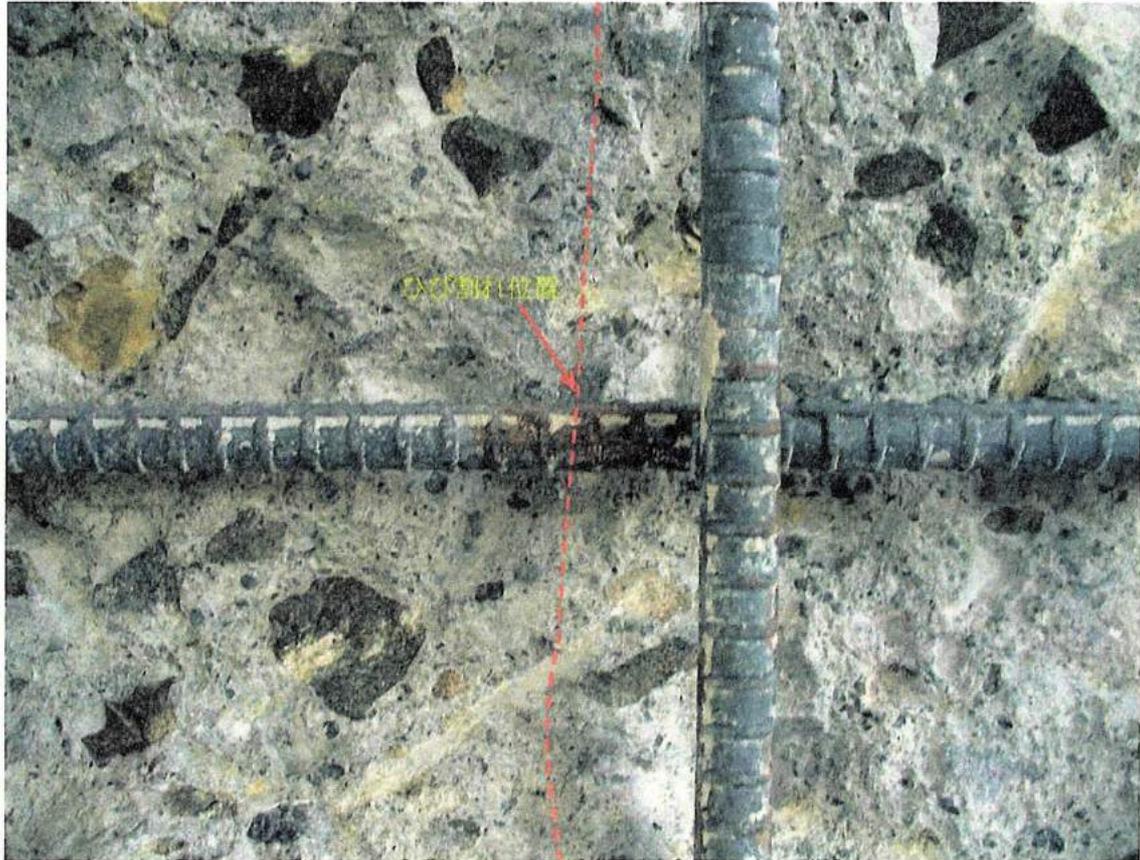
調査点B(屋外, ひび割れ有り)で観察された鉄筋の発錆箇所
